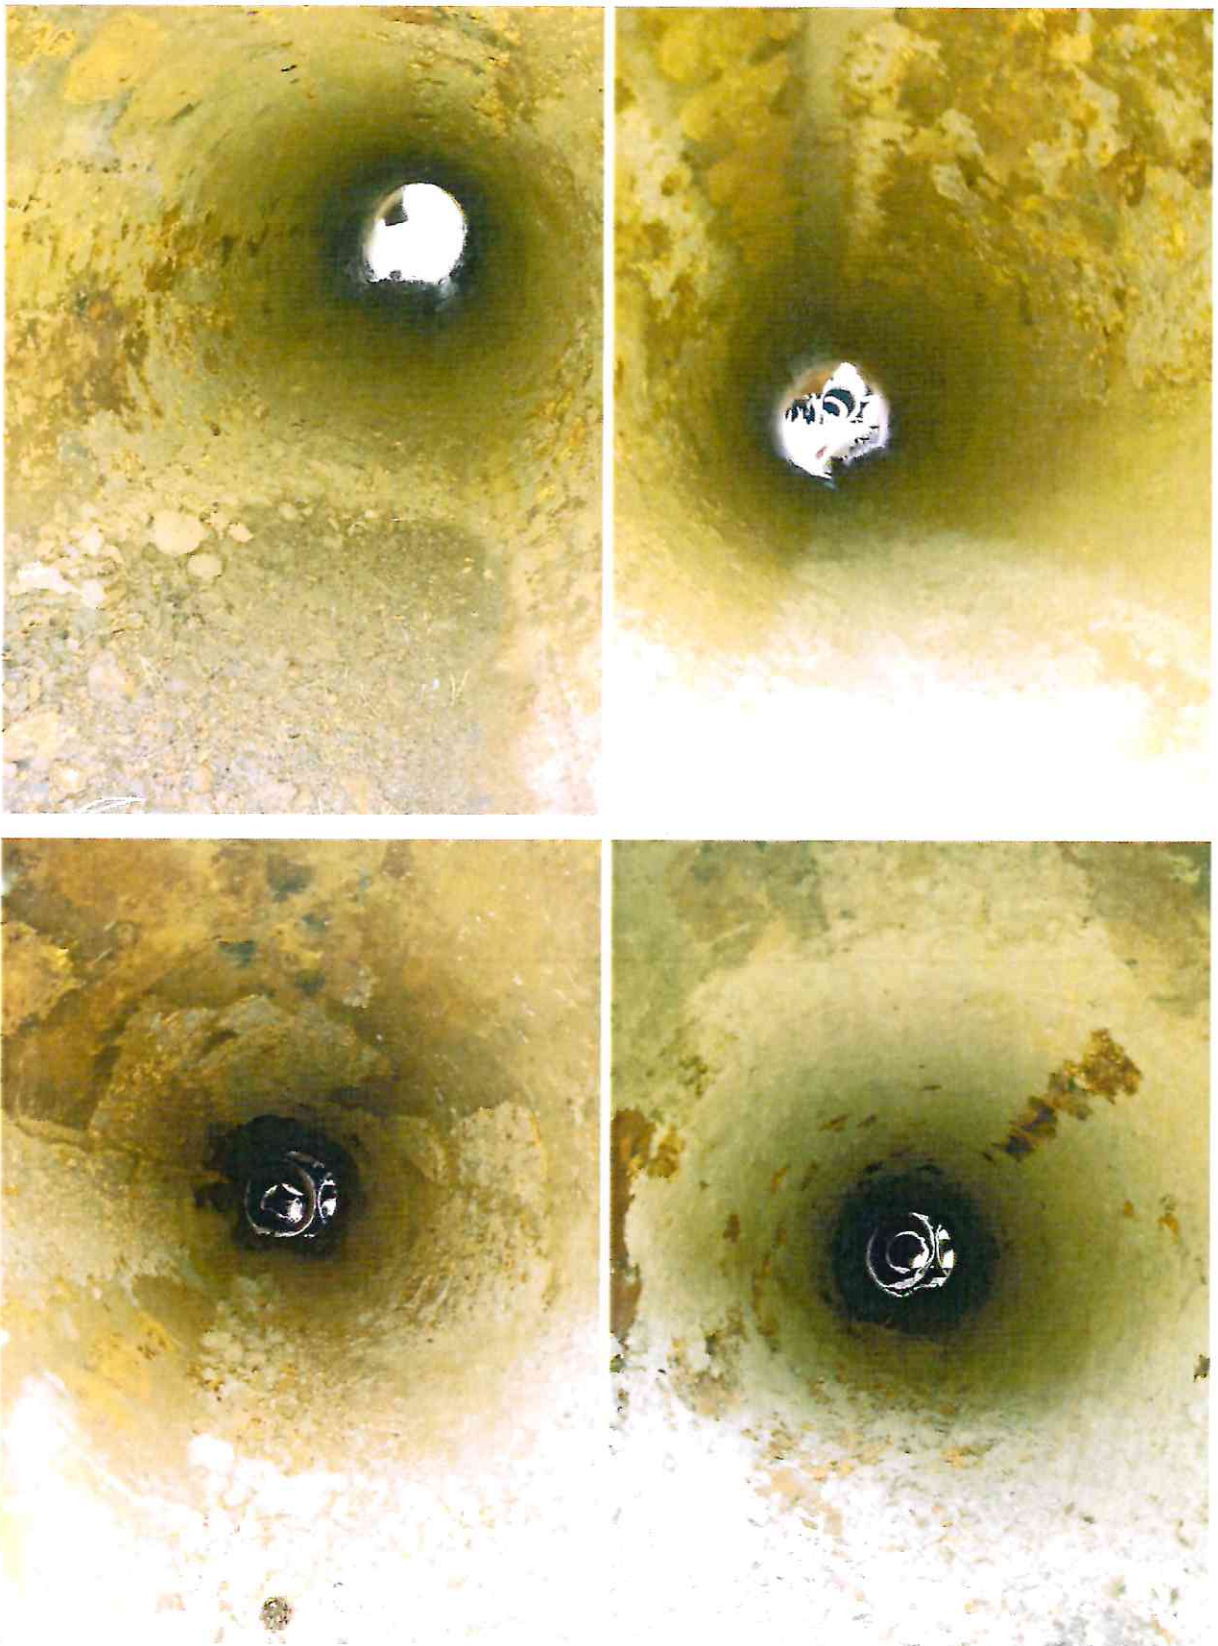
Состояние внутренних стенок труб (отложения на стенках, коррозионные повреждения).
